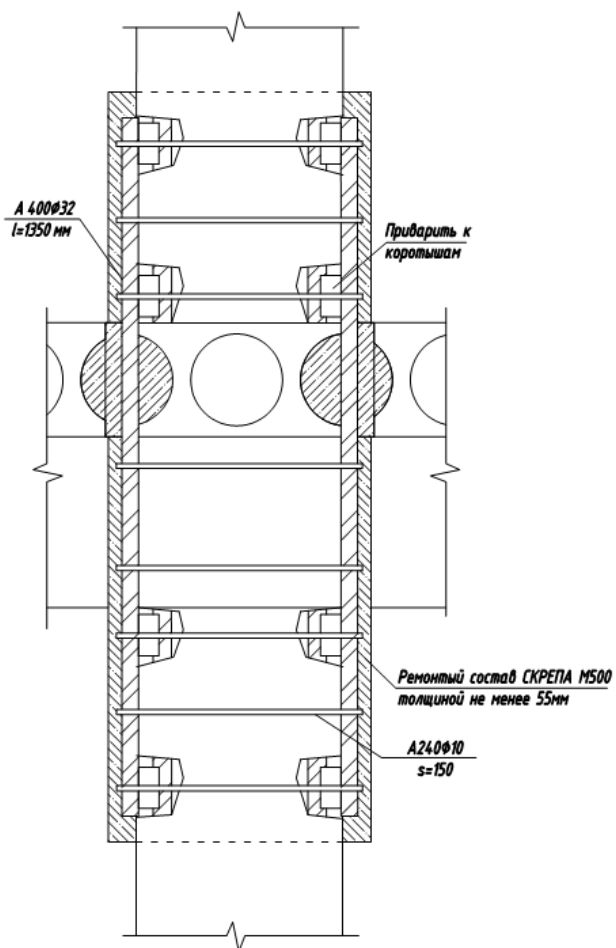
Усиление узла с помощью местной железобетонной обоймой
